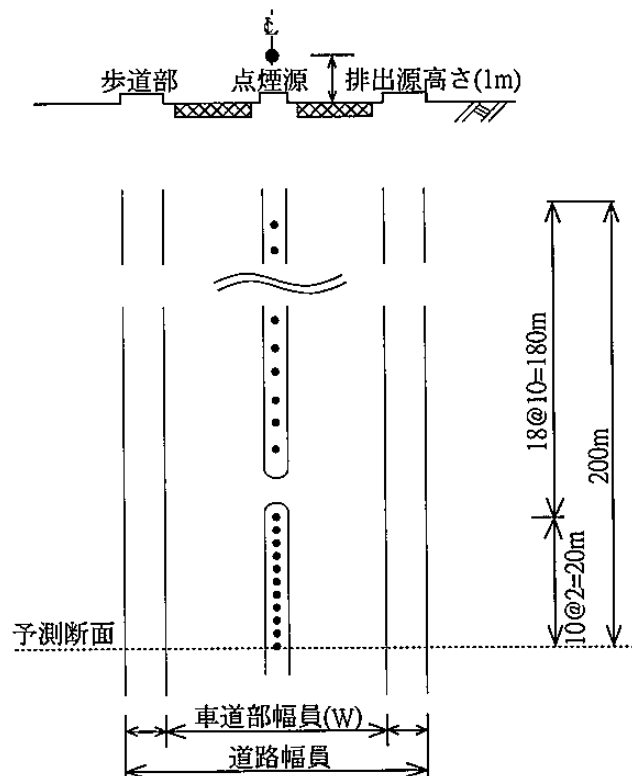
排出源の位置図 (断面及び平面図)
